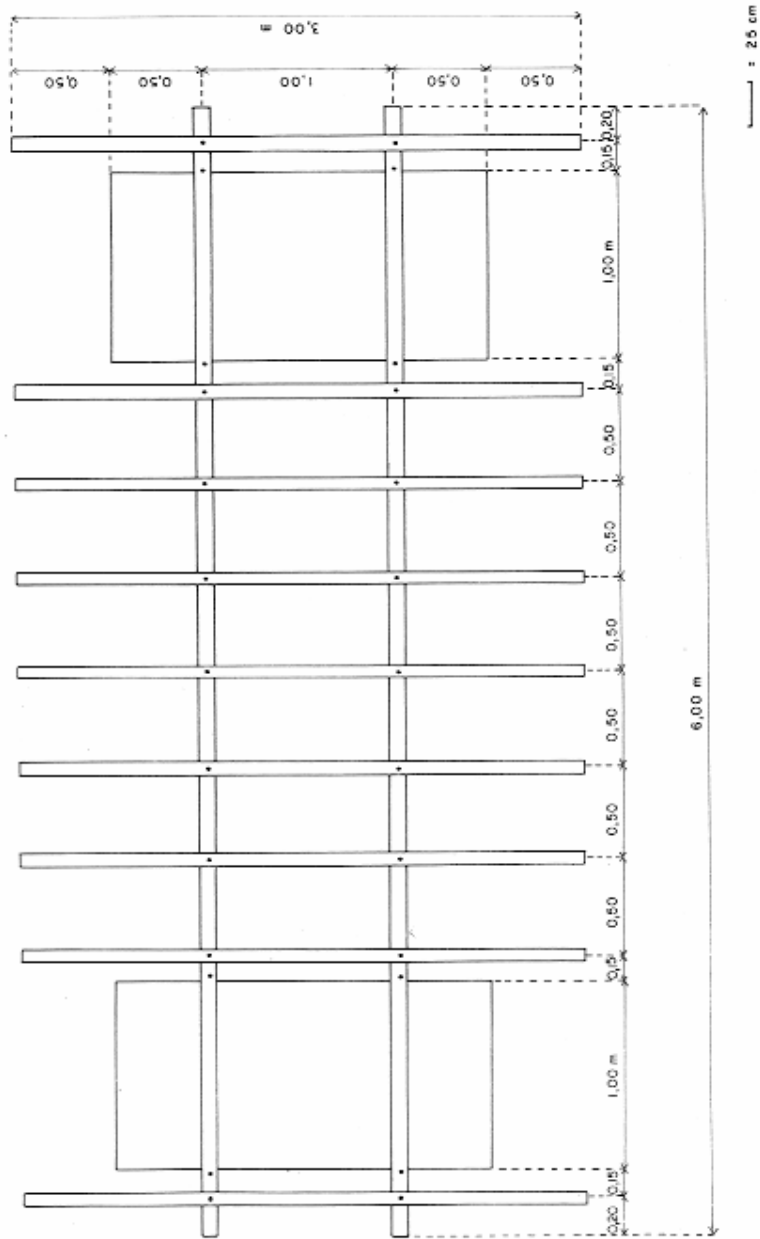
Planta baixa — Bolsa modelo A (3 x 6 m). Escala 1:25
